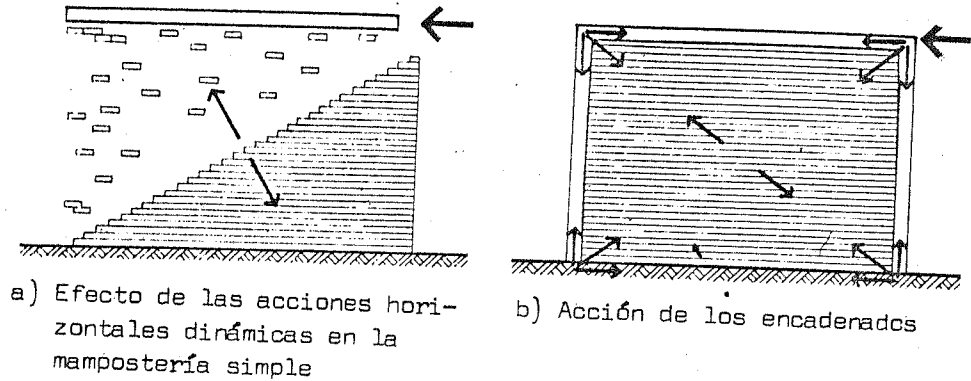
La mampostería sometida a acciones dinámicas horizontales
